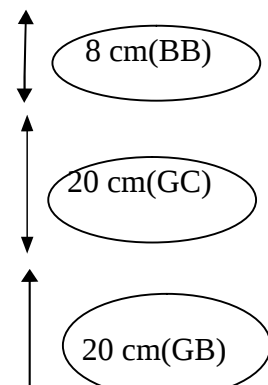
Corps de chaussée dimensionné avec la méthode CBR
